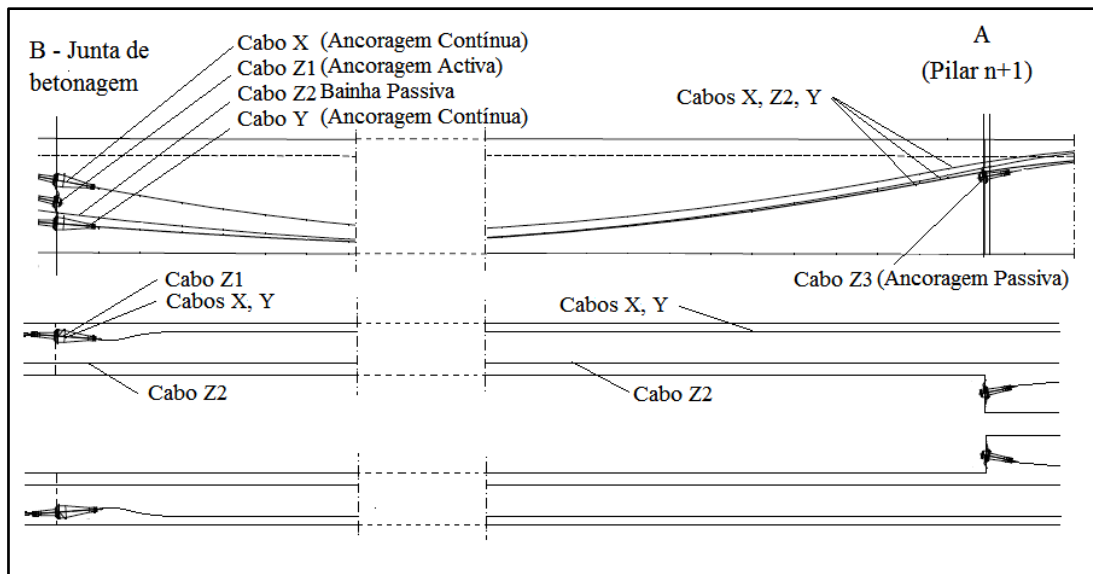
Corte longitudinal (em cima) e planta (em baixo) do traçado dos cabos de pré-esforço entre a junta de betonagem e o pilar N+1
